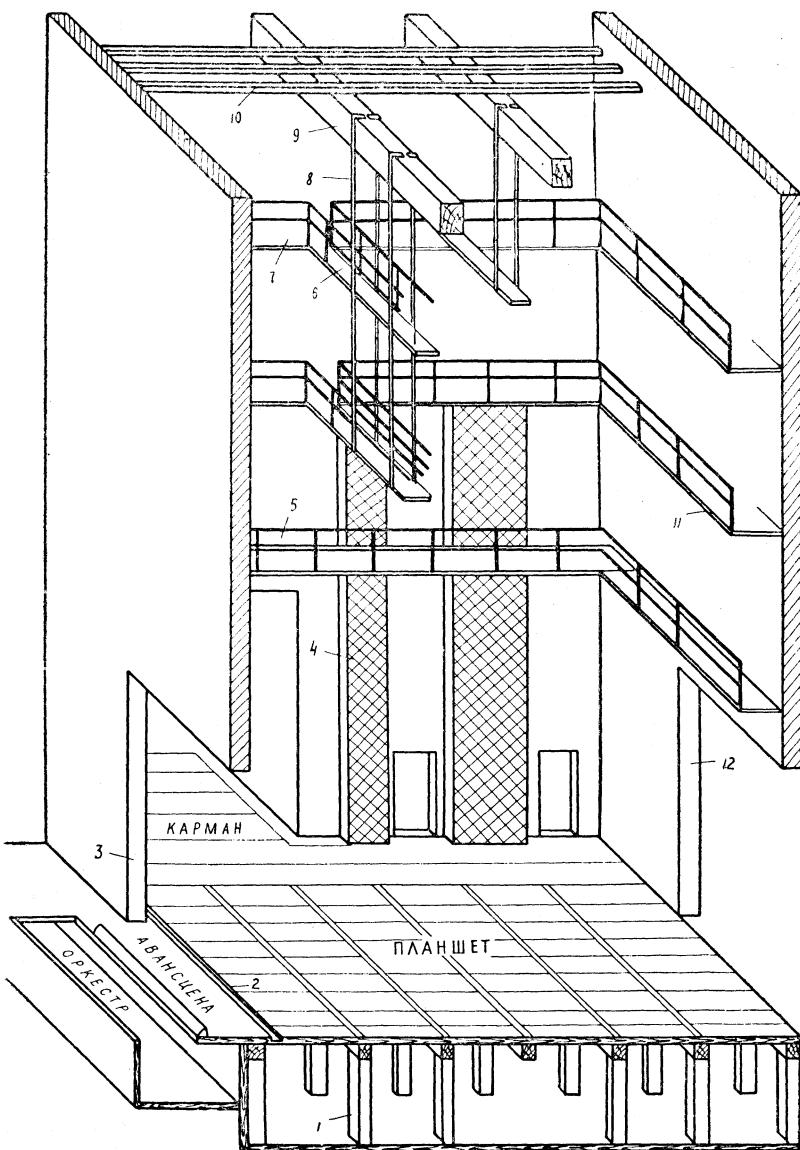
Общий вид сценической коробки в разрезе: 1 — каркас сцены; 2 — ковровая щель; 3 — портал; 4 — шахта штанкетных подъемов; 5 — первая галерея; 6 — переходный мостик; 7 — третья галерея; 8 — ферма мостиков; 9 — балка перекрытия сцены; 10 — колосники; 11 — задняя галерея; 12 — арка арьерсцены.
